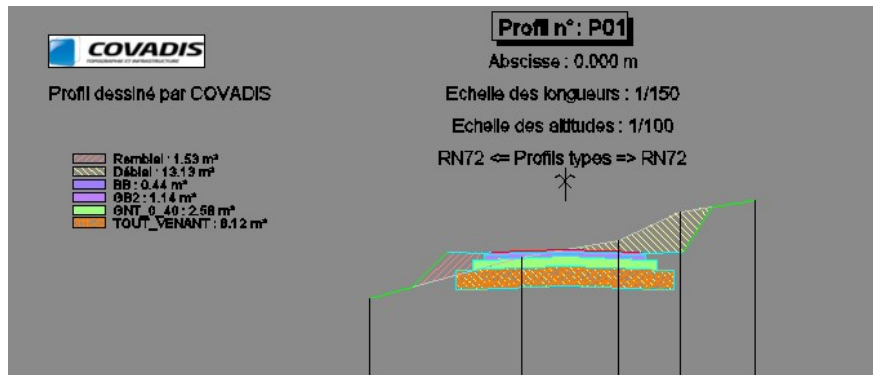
Profil en travers mixte (Déblais / Remblais).
